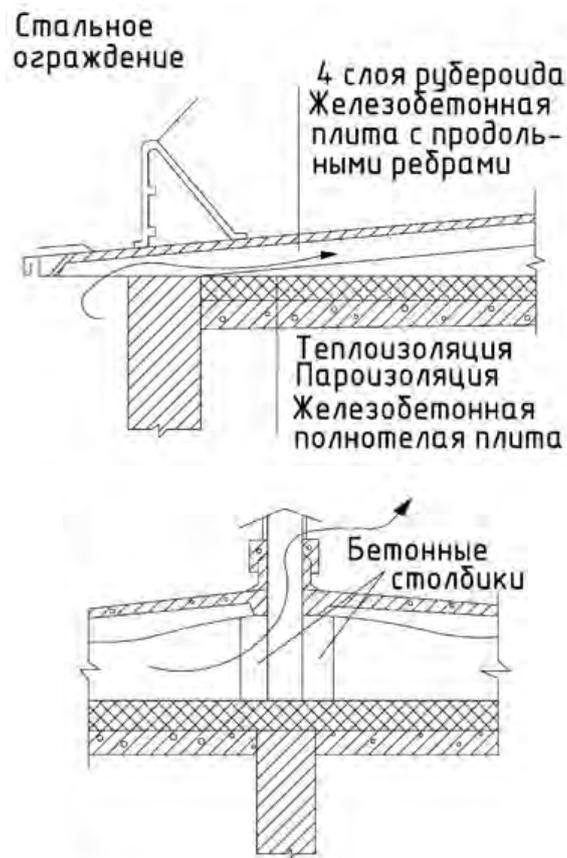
Конструкция вентилируемого бесчердачного покрытия с наружным водоотводом
